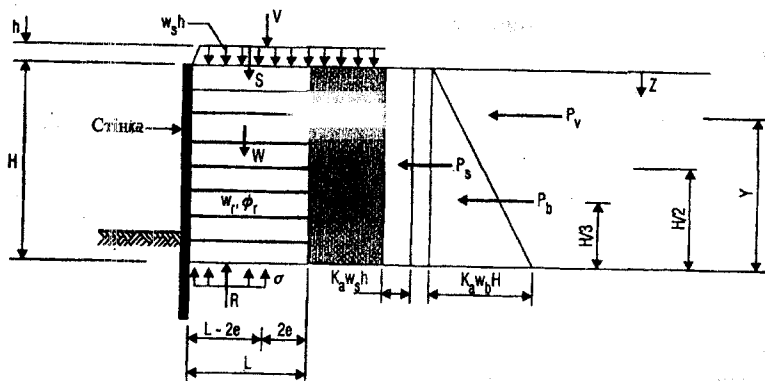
Схема розрахунку армоґрунтової підпірної стінки при поверхні ковзання у формі клину
